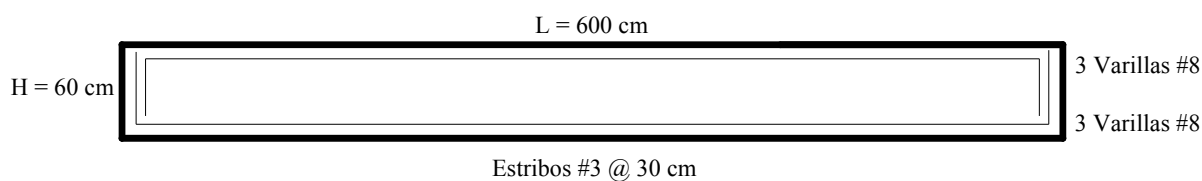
Diseño longitudinal de la contratrabe de la zapata; muro de carga apoyado a lo largo de la zapata.
